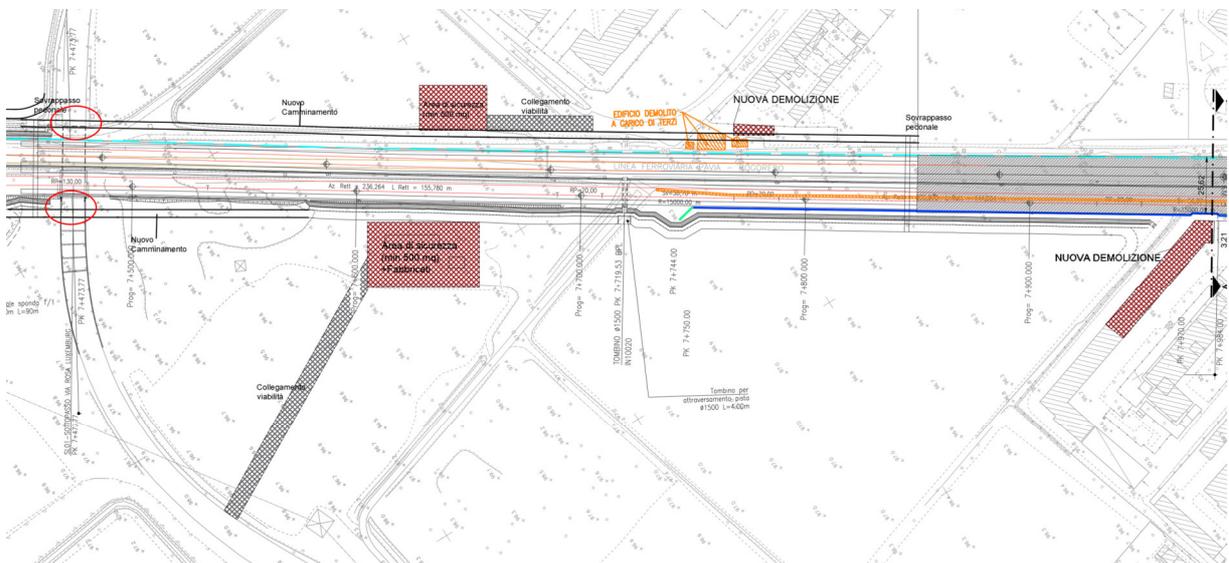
Stralcio planimetrico imbocco direzione Milano con collocazione delle aree di sicurezza.
